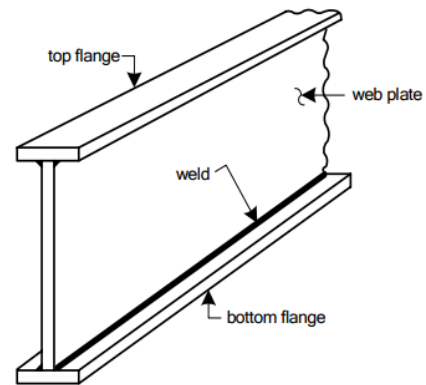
Viga armada, con soldadura – Sin redundancia interna..[6]
